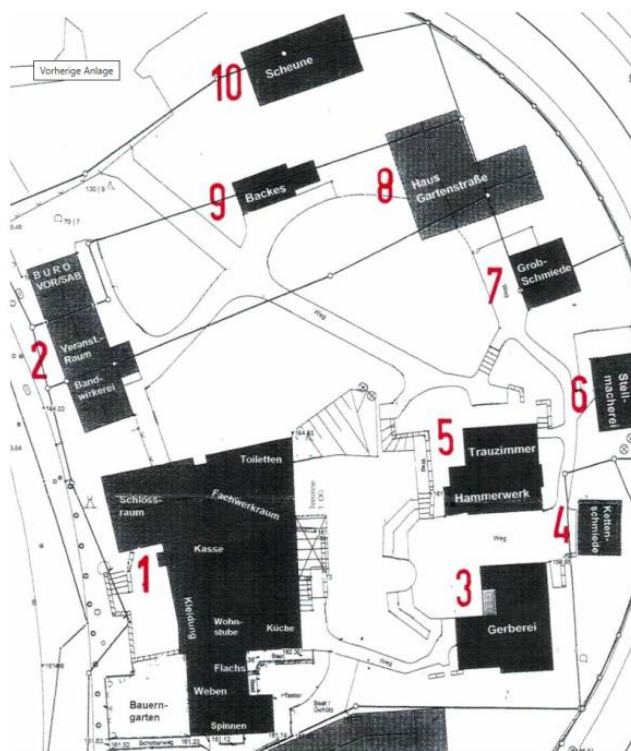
Lageplan mit Bezeichnung der Gebäude
